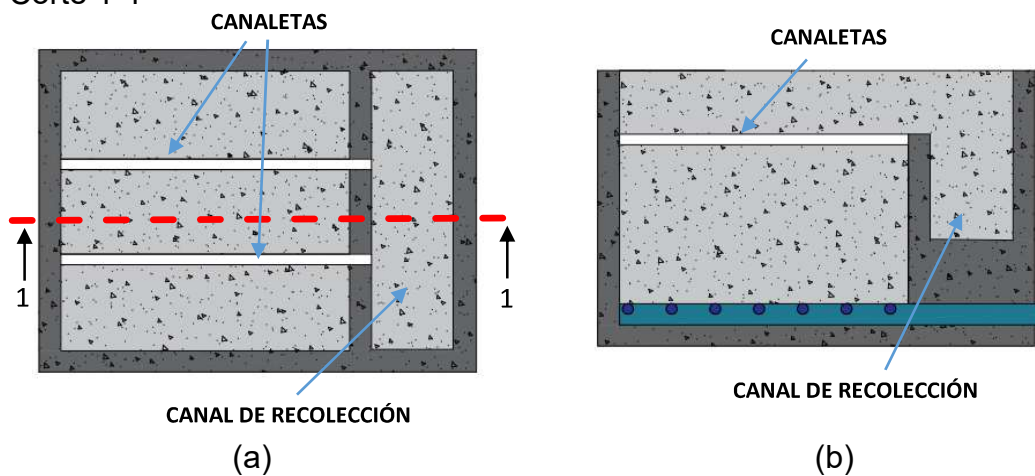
Canal de recolección ubicado al centro del filtro: a) Vista en planta, b) Corte 1-1
